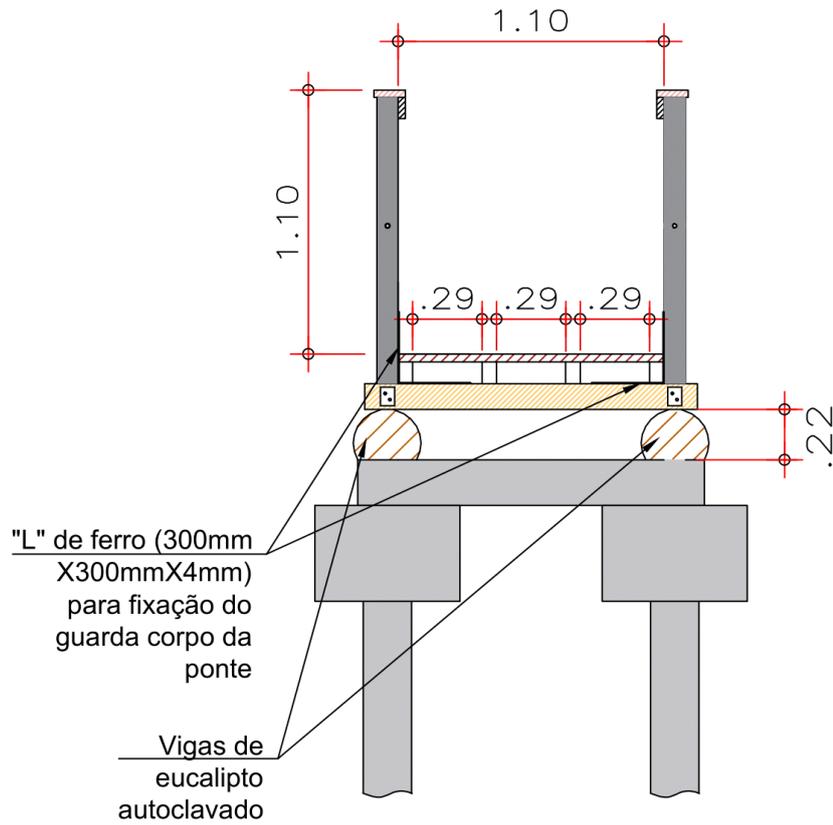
Corte transversal da ponte (indicação das peças de travamento de grada -corpo em "L" de ferro.
